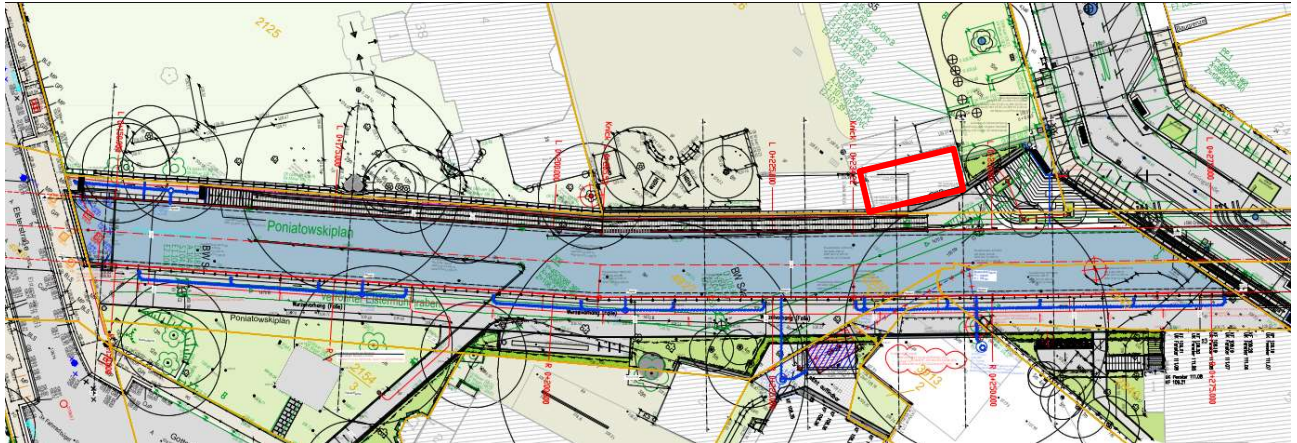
Lageplan Objektplanung mit Darstellung des Mädchen-WC (rot)
